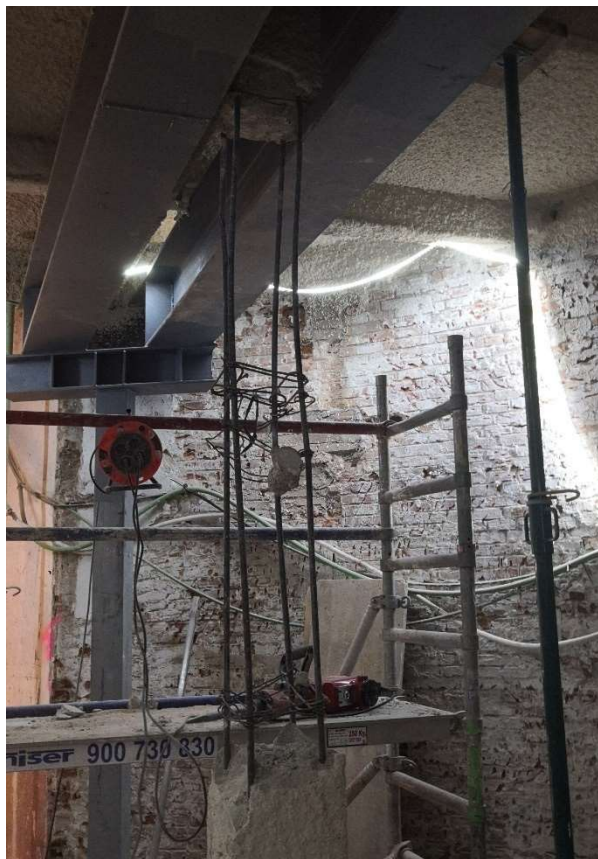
Vista de la demolición del pilar con el forjado sustentado por las dos vigas metálicas.
